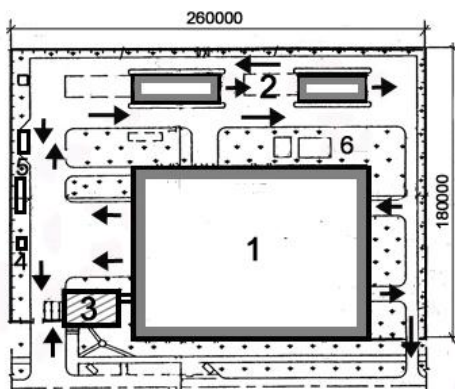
Схема генерального плана автобусного парка: 1 – производственный корпус; 2 – здания ЕО; 3 – административно-бытовой корпус; 4 – автозаправочный пункт; 5 – очистные сооружения; 6 – площадка для отдыха
